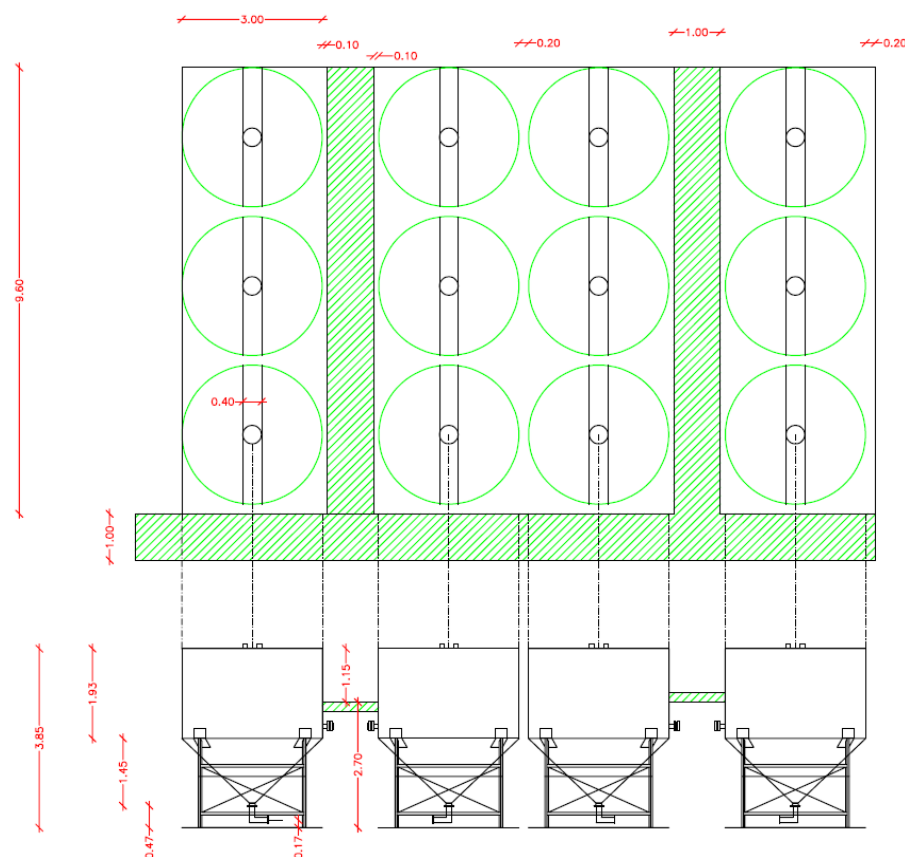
Vista laterale (in basso) e in pianta (in alto) dei 6×2 decantatori
